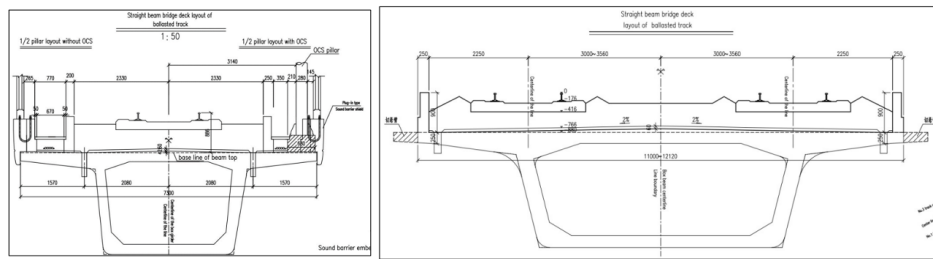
ilustrasi struktur penampang elevated Rail LRT
